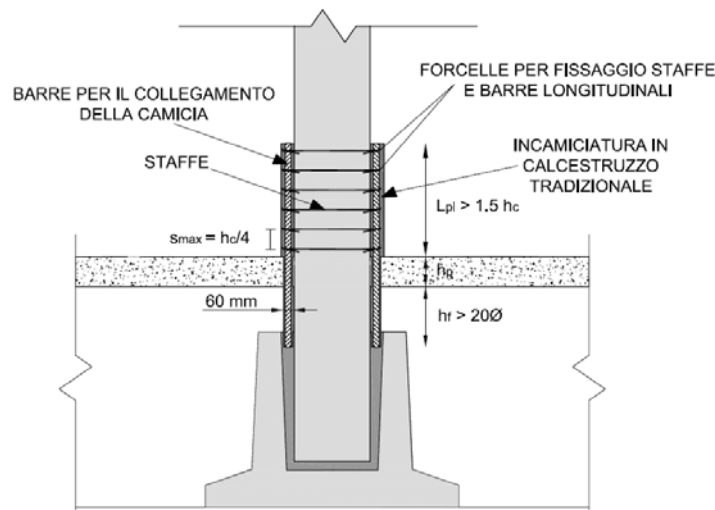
Incamiciatura in calcestruzzo tradizionale
